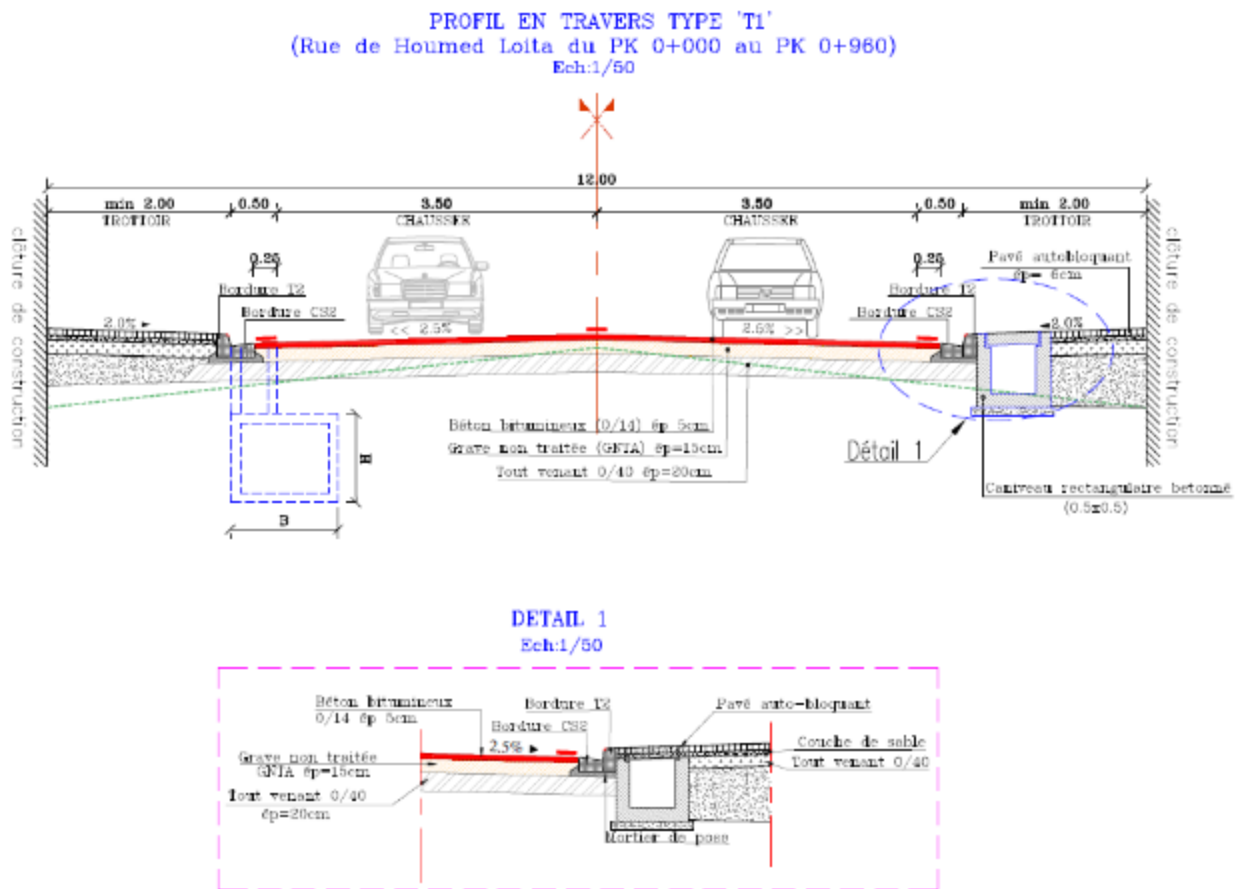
profil en travers Type « T1 » rue Houmed Loita (Source : APS de l'étude 2024-2025)
